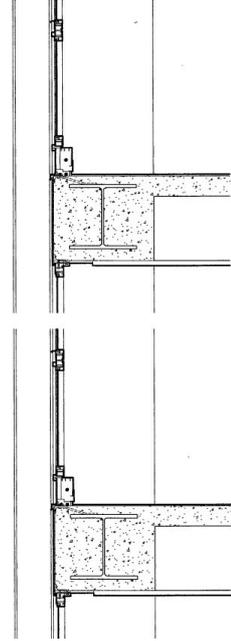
Sección vertical de fachada de apartamentos Lake Shore Drive.
